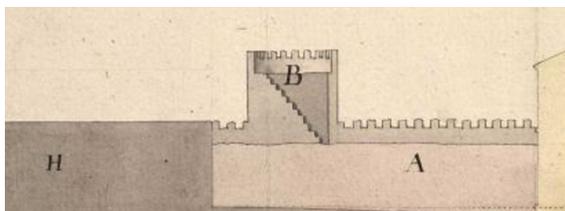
Detalle del alzado interior de uno de los cubos y adarve de la muralla entre la puerta de Santa Clara y la de San Pablo en 1750. AGS, MPD, 23-027.
